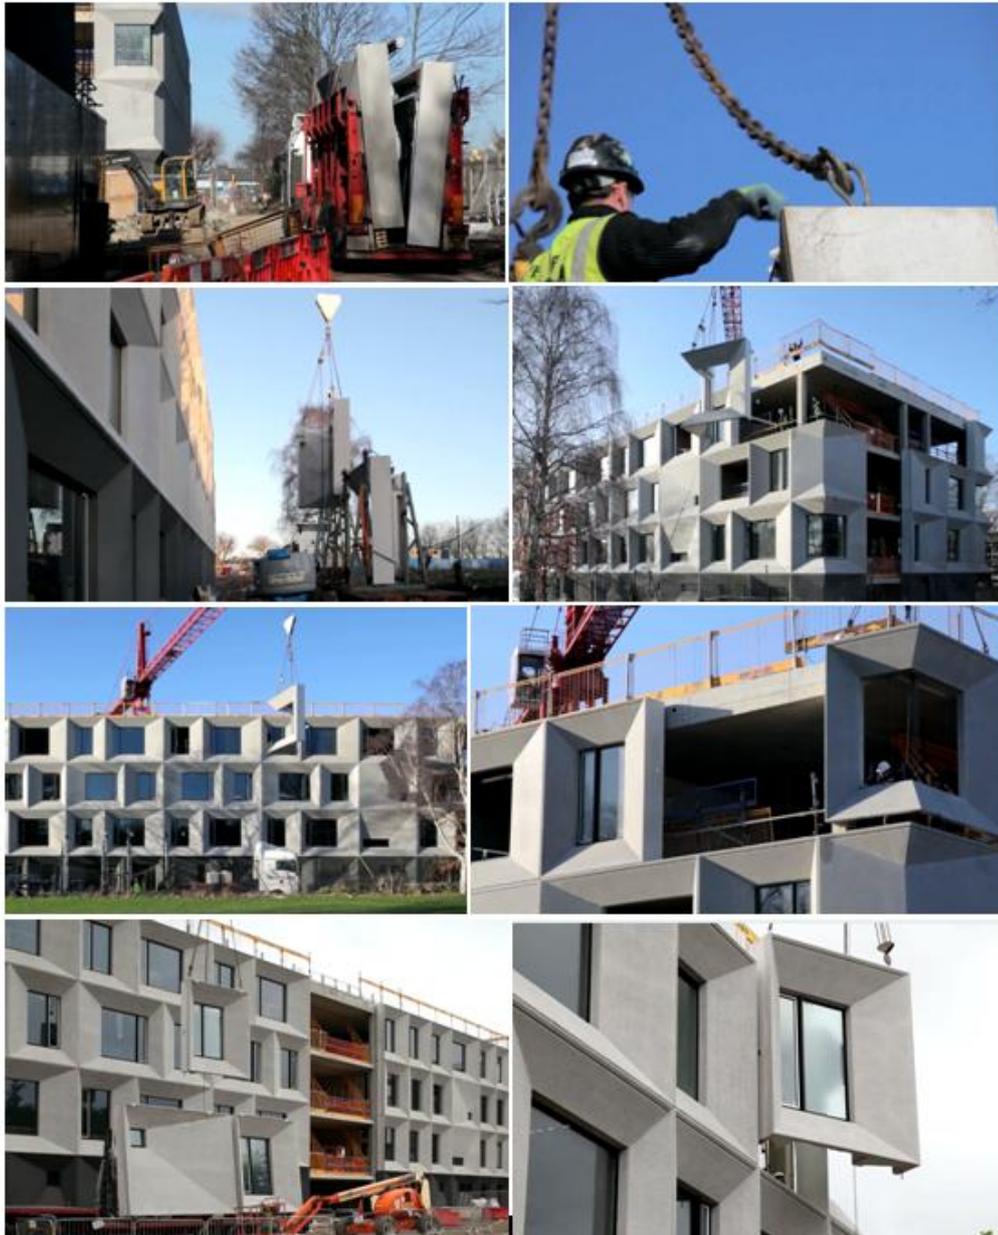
Pannelli prefabbricati in Burntwood School, Londra 2015.
